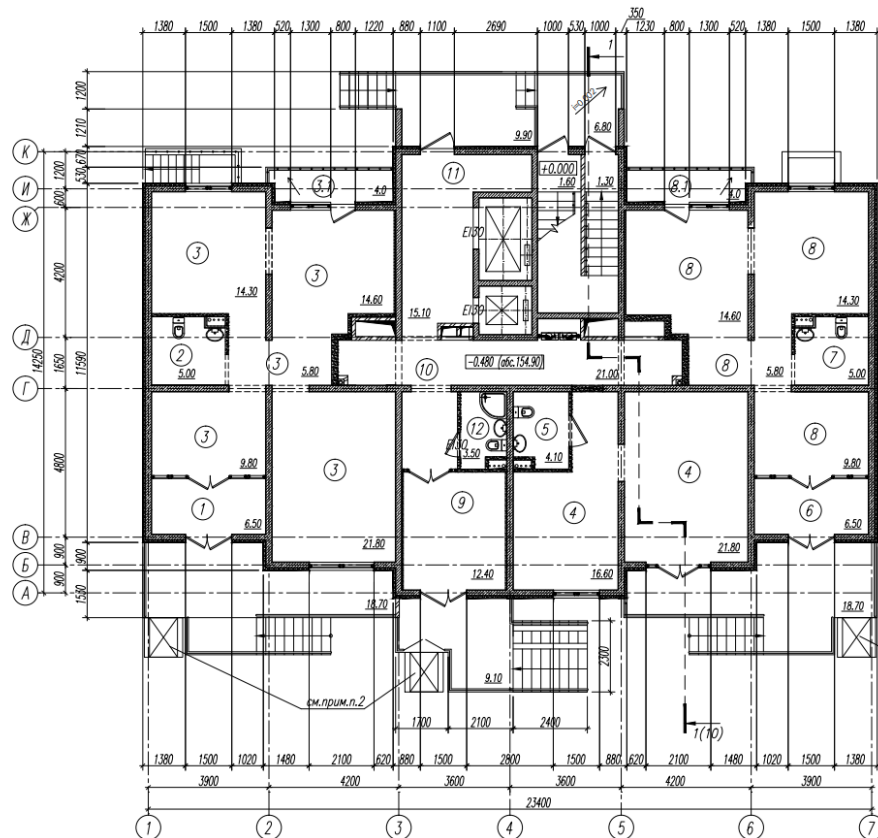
План 1-ого этажа 6 литеры ЖК «Горный квартал»
